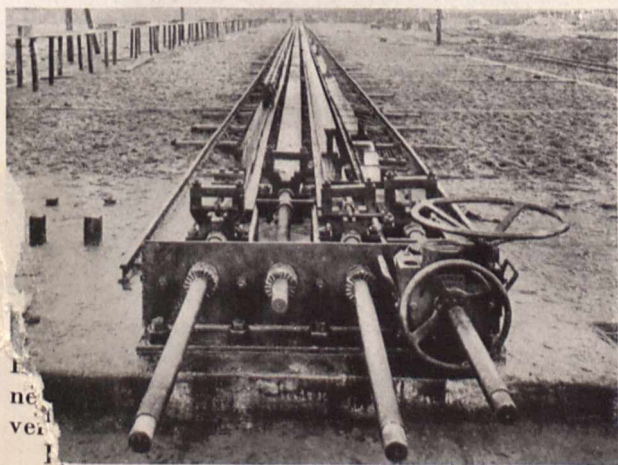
Spannvorrichtung zur Herstellung eines 100 m langen Stahlsaitenbetonträgers
